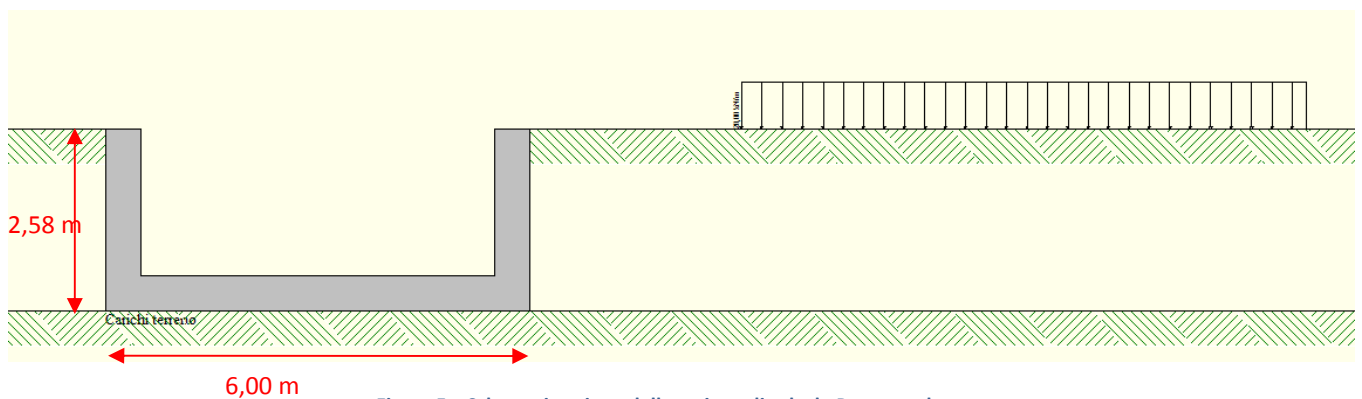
Schematizzazione della sezione di calcolo Pozzetto sbocco
